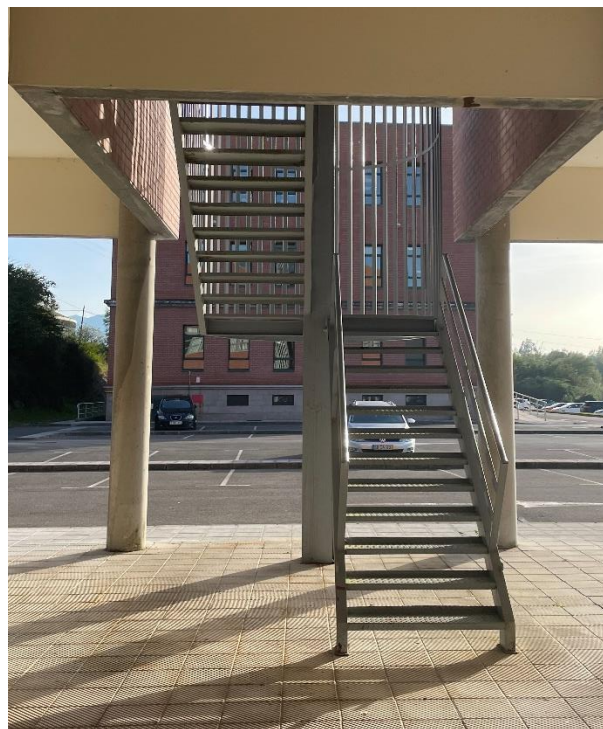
Fotografía de la estructura metálica que cubre las escaleras del tramo este, se puede ver que sólo llega hasta el descansillo de la planta baja
